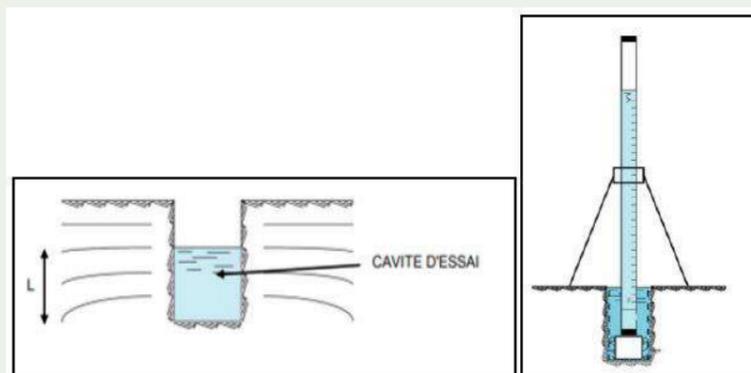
schéma de principe de l'essai Porchet (Etude géotechnique G2 AVP+PRO, Fondasol, 2020)
